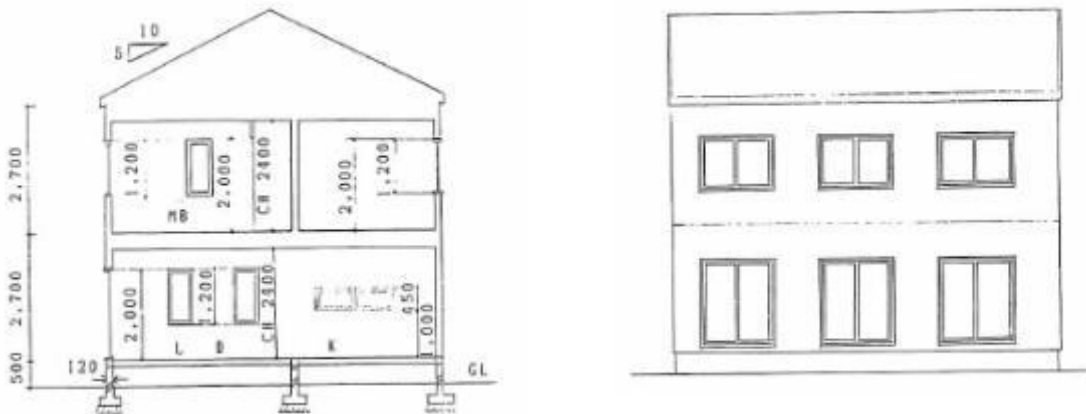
日本建築学会標準住宅モデル(木造)断面図・立面図
